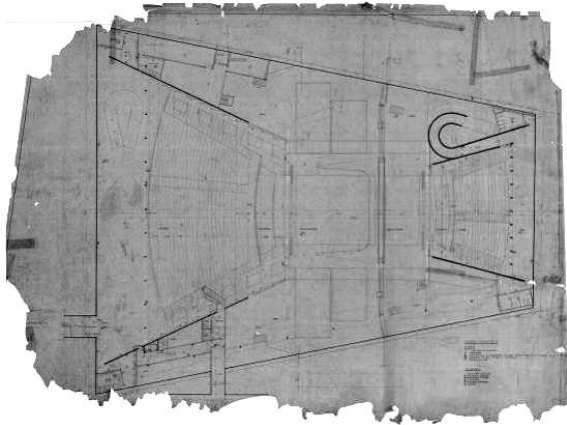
Planta Baixa do Teatro Nacional, nível -3.80m, década de 60. Fonte: ARPDF.
